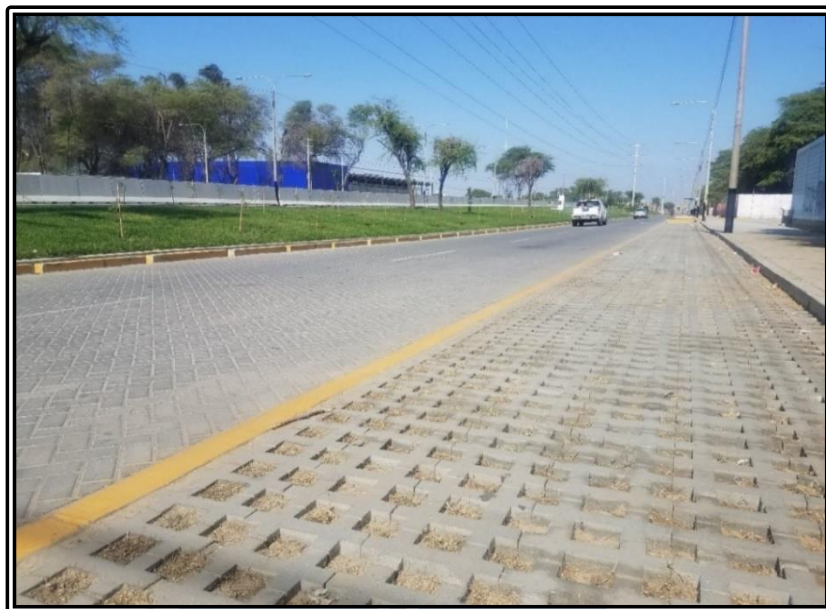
Construcción de calzada auxiliar con bloques de concreto y de redes eléctricas a lo largo de Av. Sánchez Cerro.
